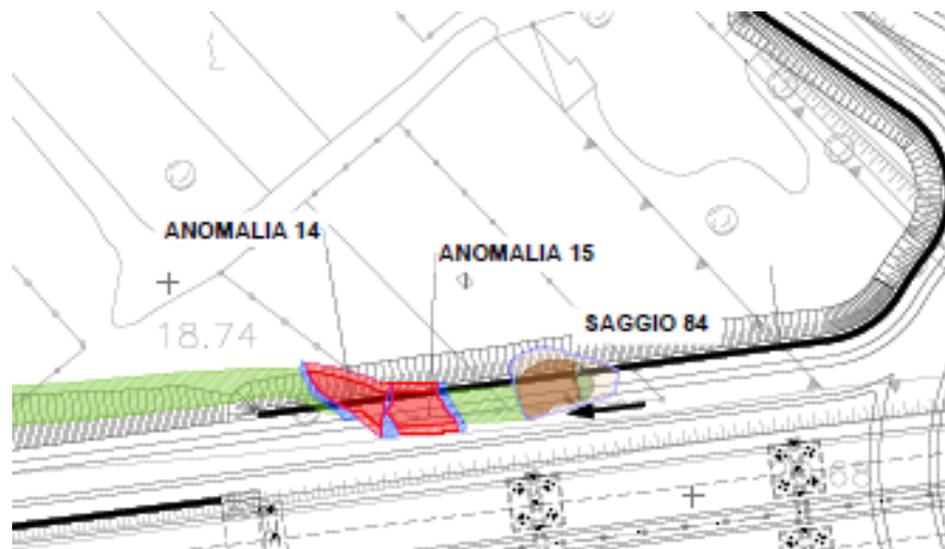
Saggio 84 (tomba Monte Claro) e anomalie: planimetria delle aree da indagare
